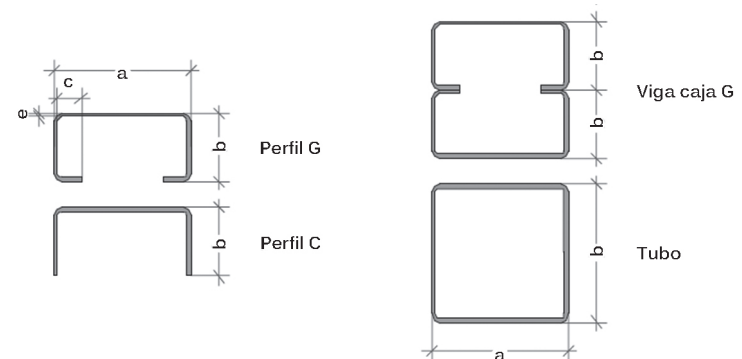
Tipos de perfiles de acero laminado.
